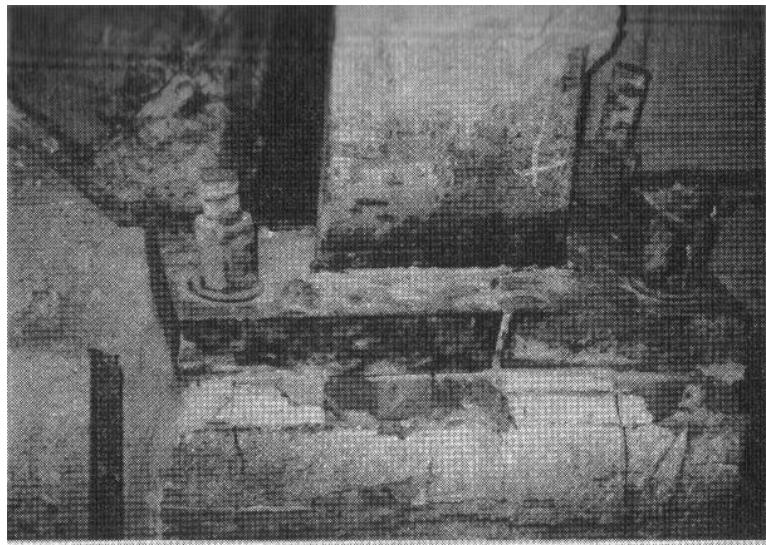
Se pueden apreciar el daño causado por el deslizamiento de las barras de anclaje en los dados de concreto. Ref. 5
